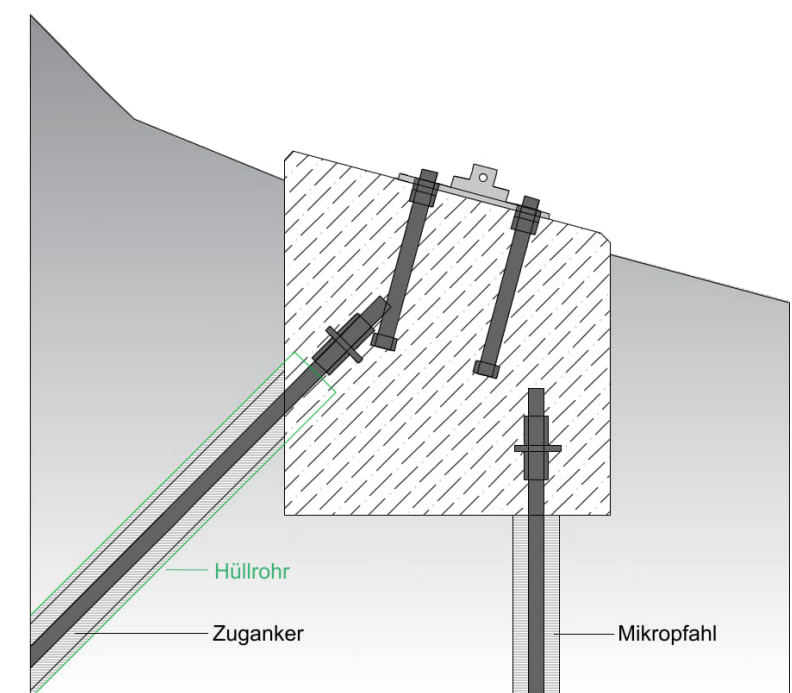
Rückverankertes Betonfundament mit Hüllrohr
